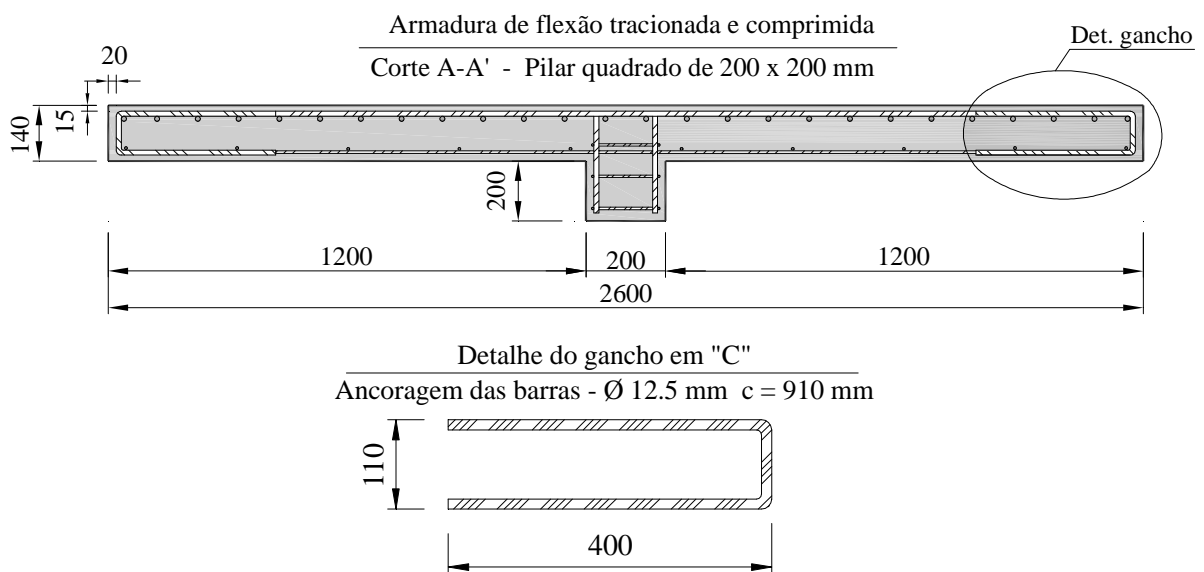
Detalhe da armadura de flexão tracionada e dos “ganchos”
